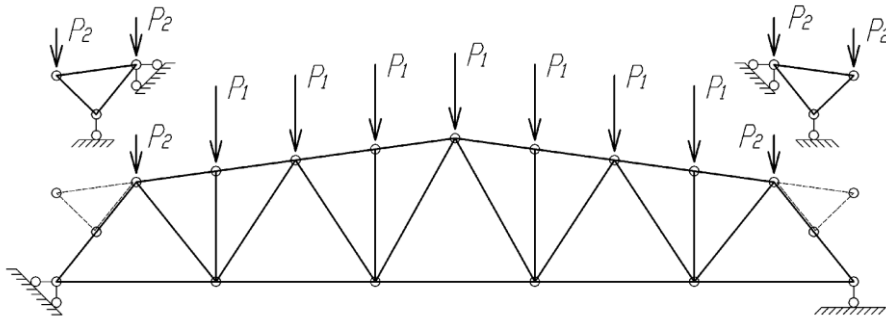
Расчетная схема основной фермы и расчетные схемы шпренгелей с нагрузкой от собственного веса кровли.
